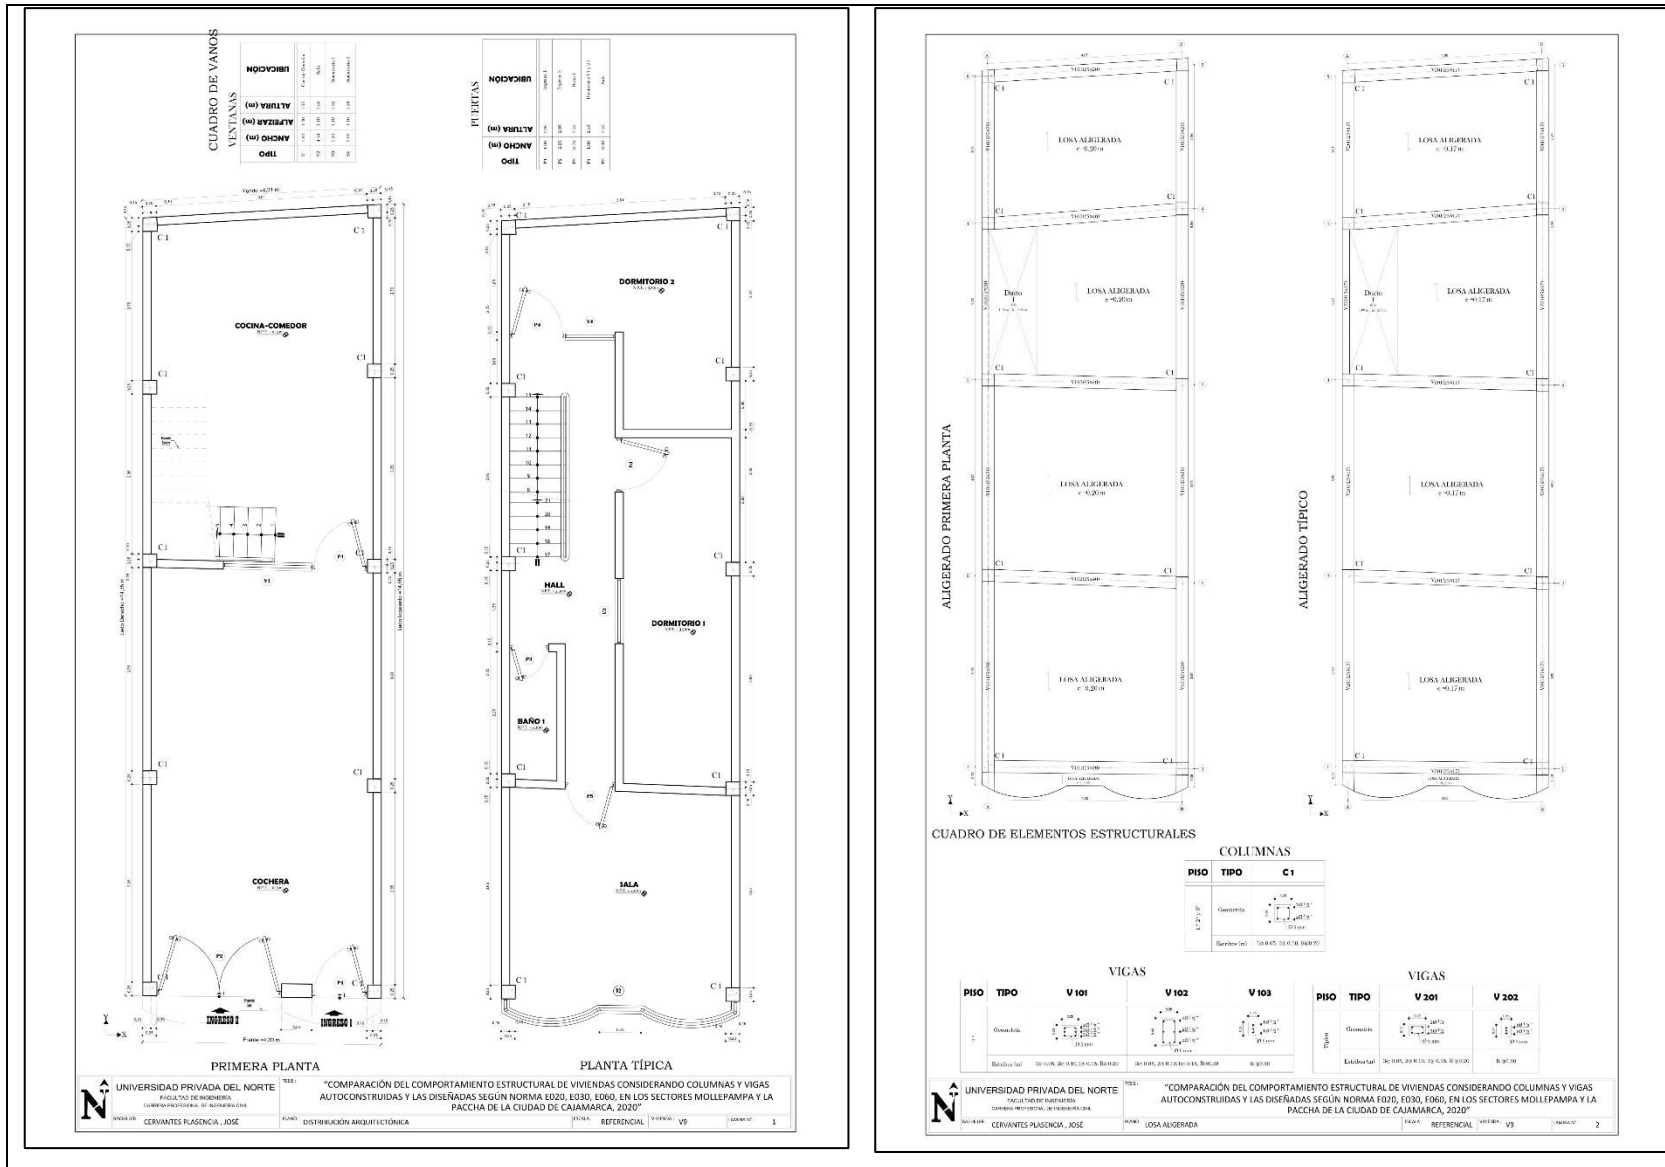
Planos de arquitectura y losa aligerada vivienda 9
